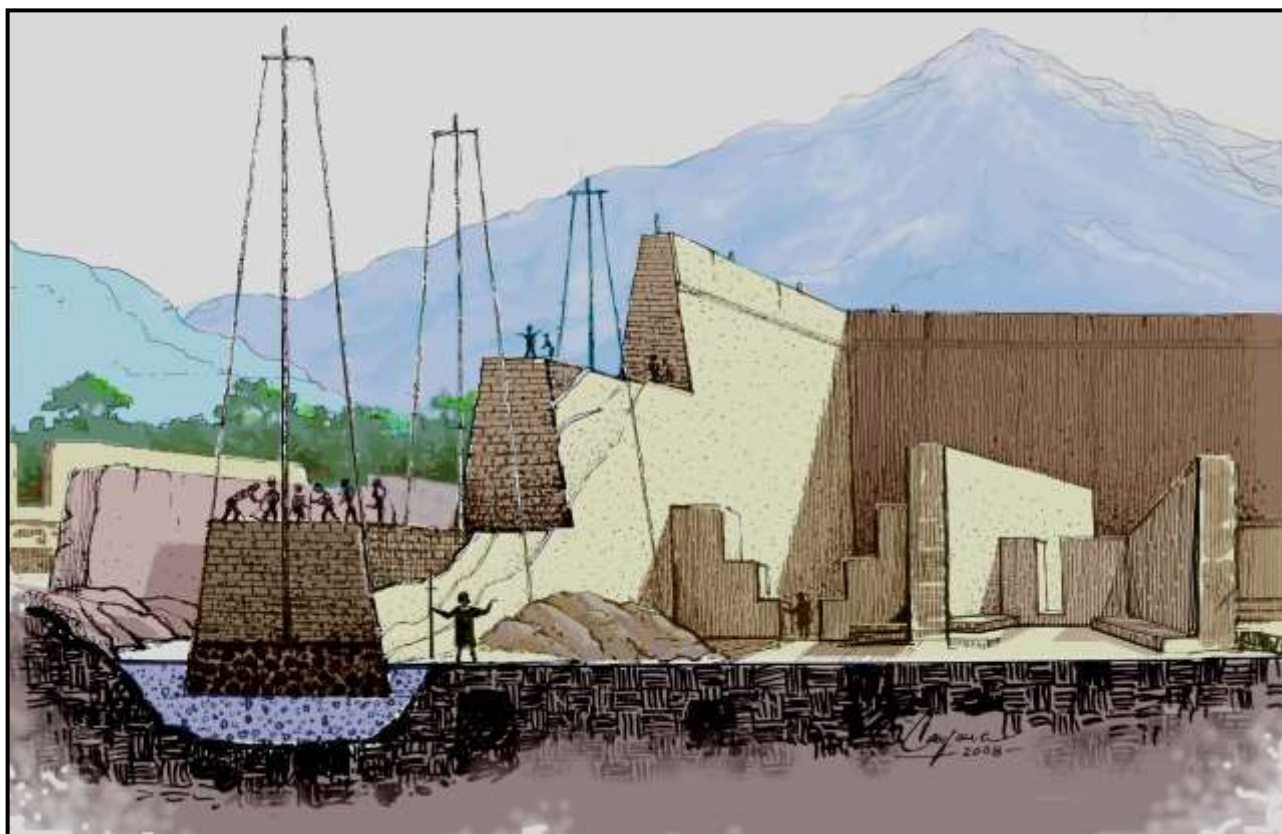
Dibujo hipotético de la estructuración y construcción de un muro perimetral. Sobre un suelo con rastros de anteriores construcciones, se hacía una zanja ancha, se le ponía cascajo en seco, luego un cimiento y un sobre cimiento con piedras grandes y barro para evitar la acción del salitre y una vez nivelado, se comenzaba a construir con adobes de tres tamaños.
